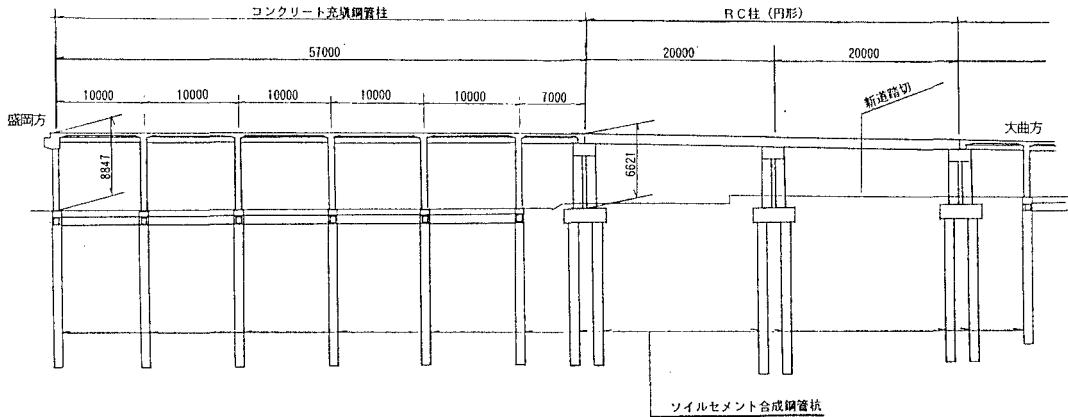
コンクリート充填鋼管柱としたラーメン高架橋の側面図
